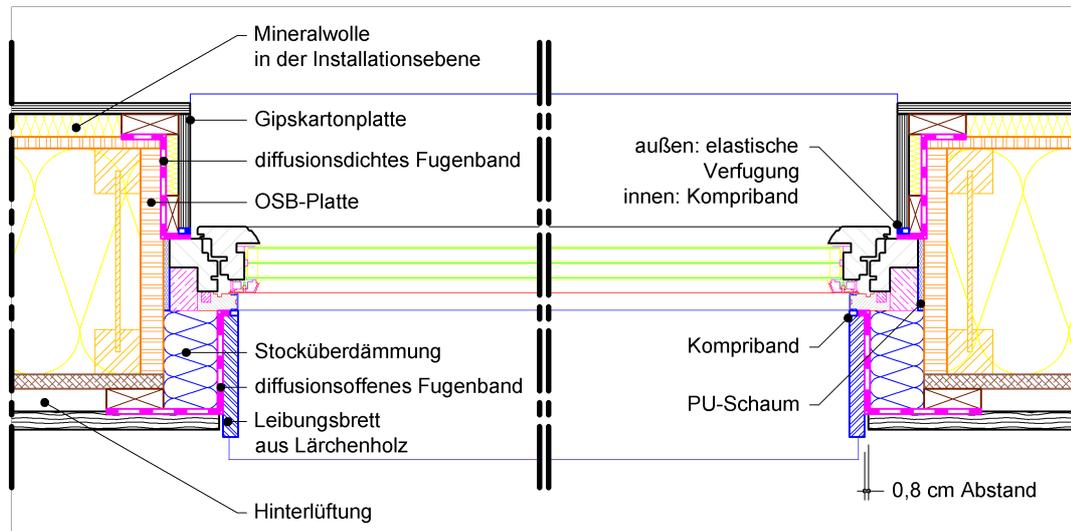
Detail G-L Holzleichtbauelement Leibung
